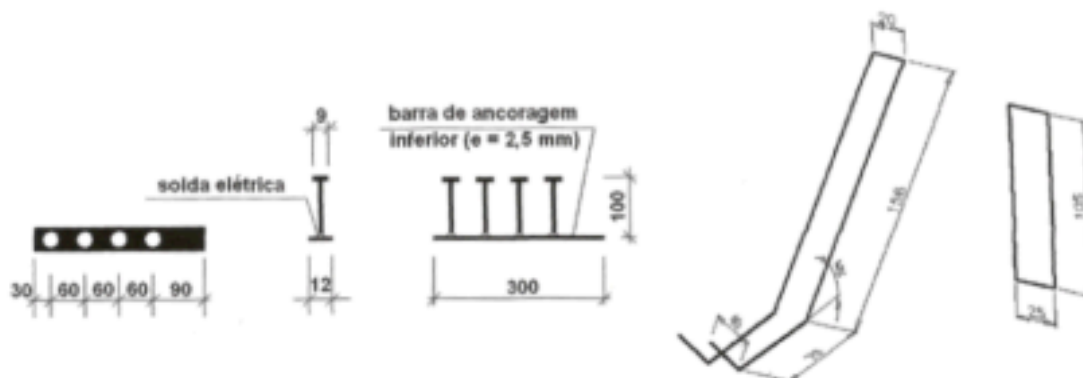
Detalhe dos pinos e estribos (medidas em mm)
